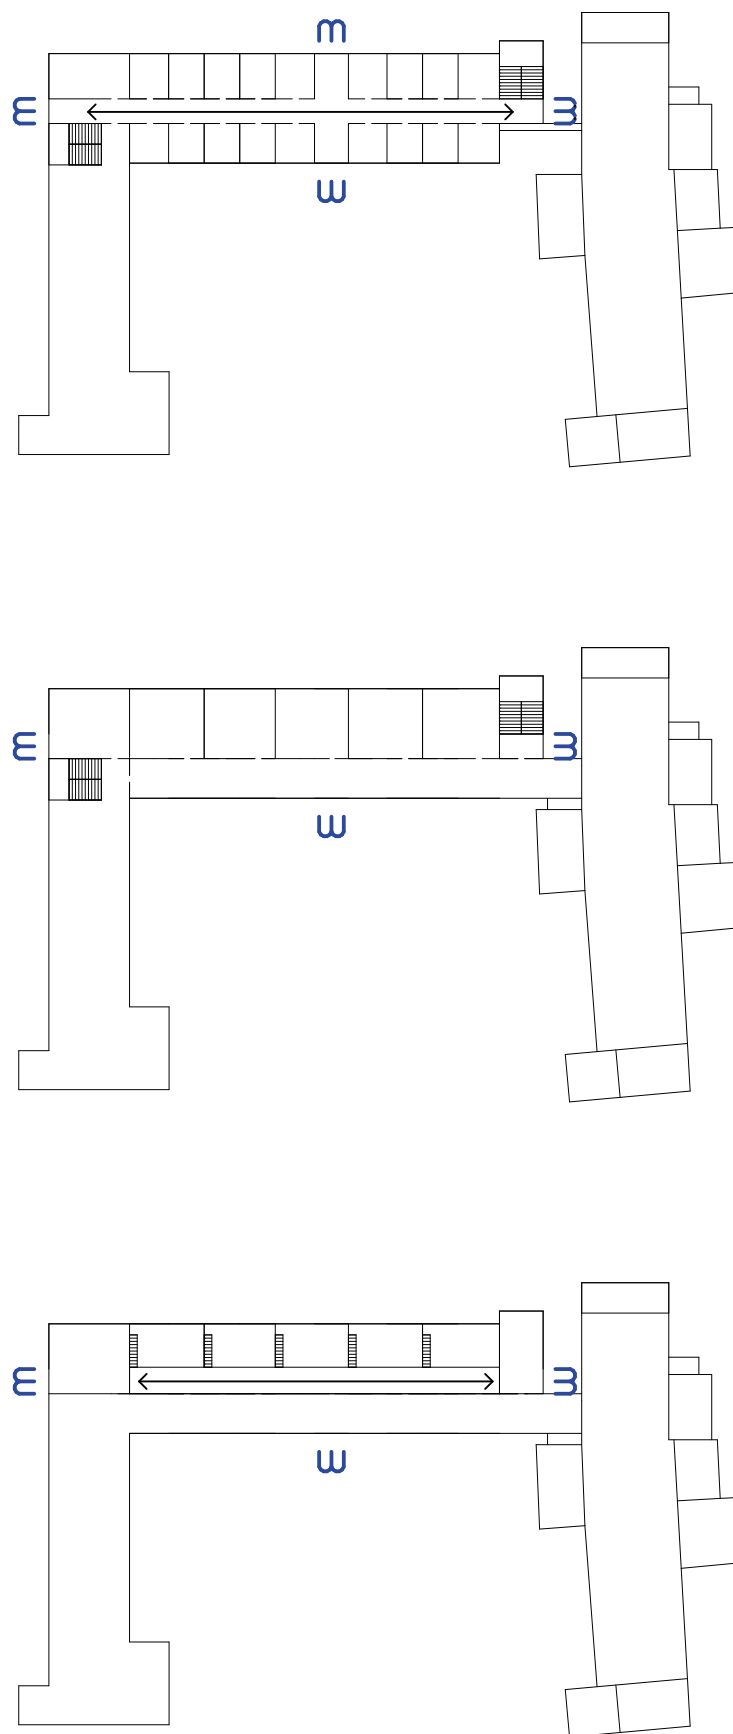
| Schematische Grundrisse des Klosters
